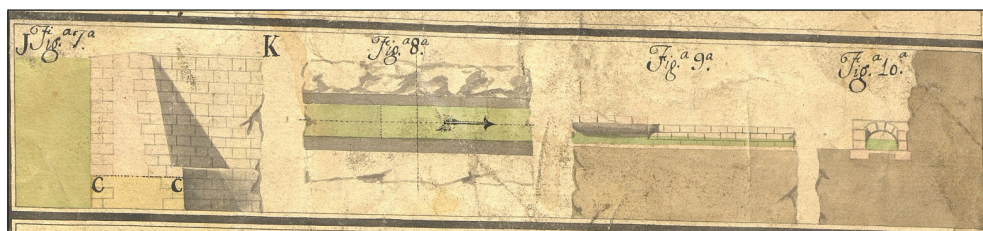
Plantas y secciones del recrecimiento y de la acequia (sección 3 del plano).
